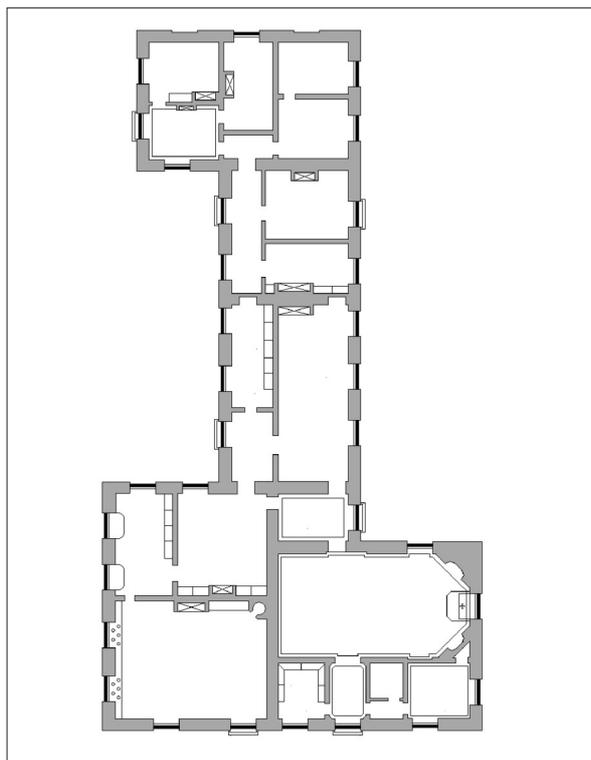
a. PLAN DU CHÂTEAU VIEUX DE REYNERIE.
